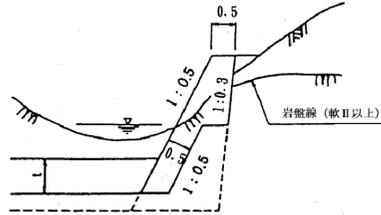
側壁護岸の構造（岩盤（軟Ⅱ以上）の場合）
